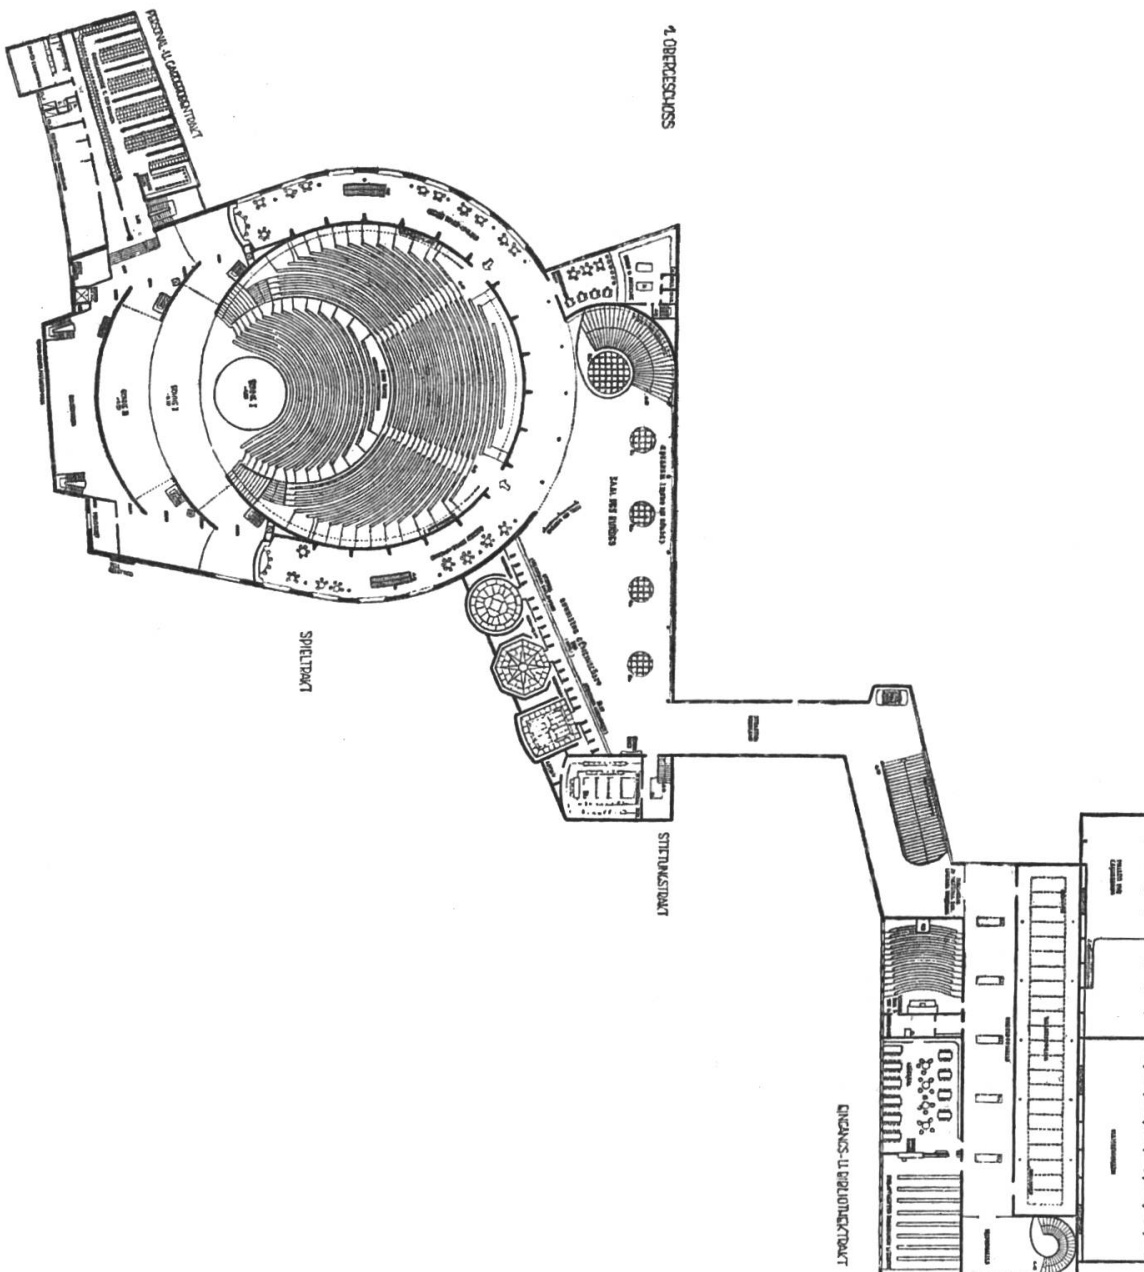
Festspielhaus Luzern, Projekt v. R. Rohn. Grundriss, Gesamtanlage.
